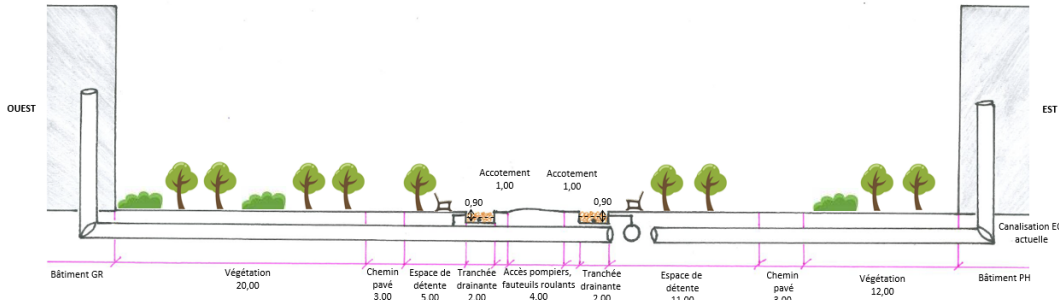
Plan de façade à façade pour le scénario 2 au niveau de la coupe 1.
